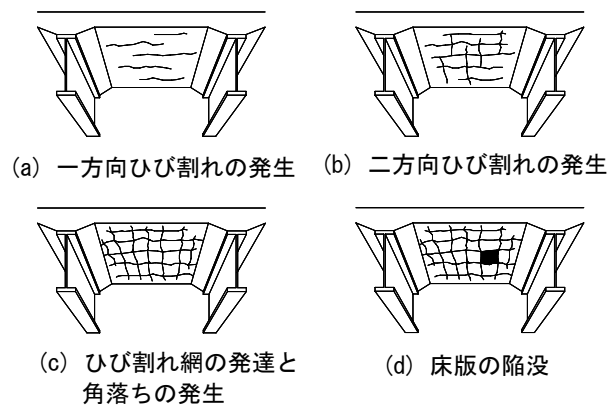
R C 床版下面のひび割れ進展過程¹⁾
